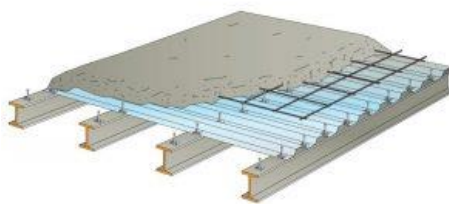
détail de plancher collaborant, source : <https://www.toutsurlebeton.fr/mise-en-oeuvre/quest-ce-quun-plancher->
